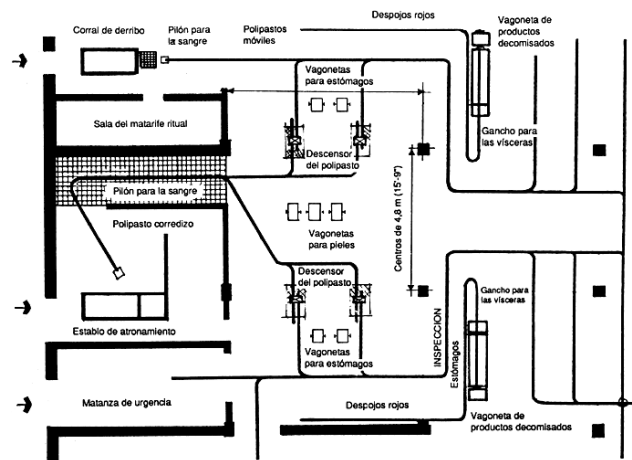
Esquema de planta de preparación de secciones múltiples. (Fuente Fao, sin año).
